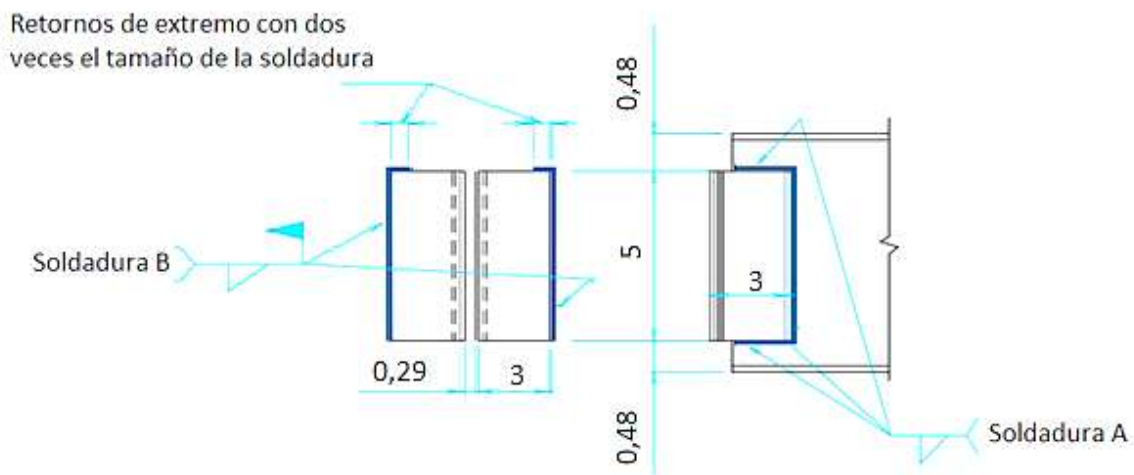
DIMENSIONES DE LA SOLDADURA A Y B
